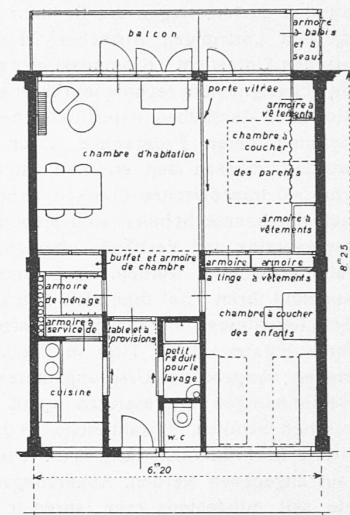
Wohnungs-Grundriss, 1 : 150.
